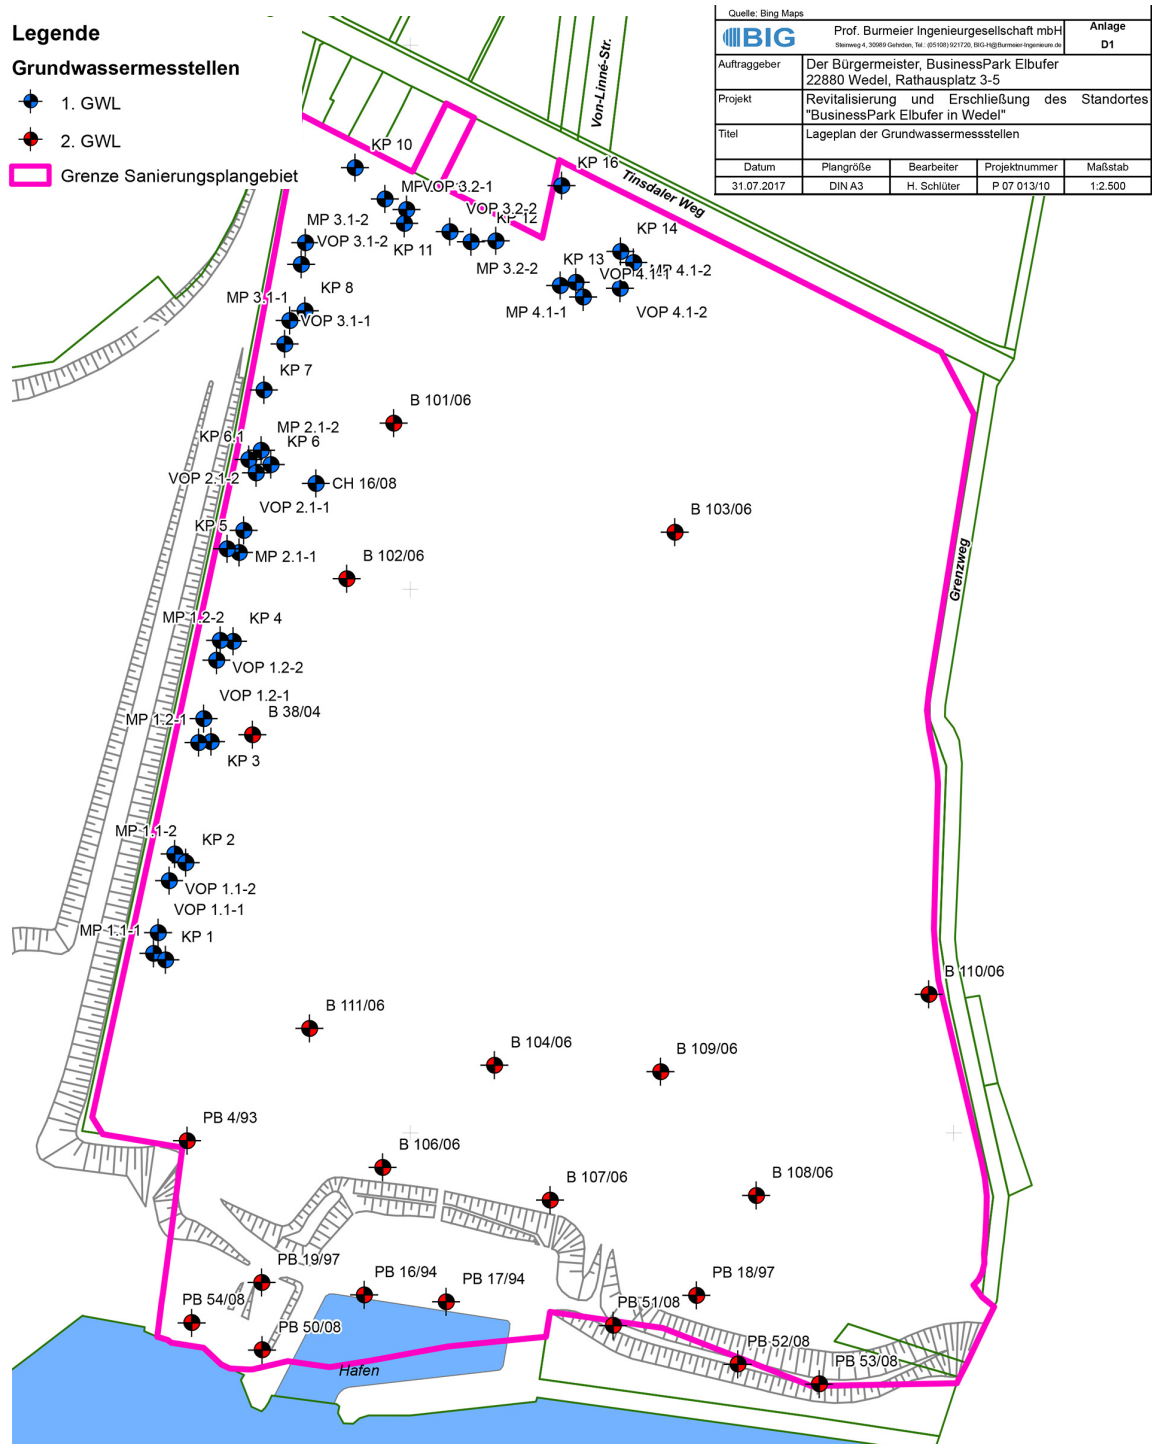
Lageplan der Grundwassermessstellen, Stand 31.07.2017
